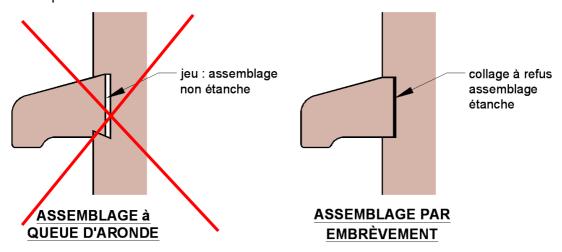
Assemblage de fil pouvant être traversé par un drainage
